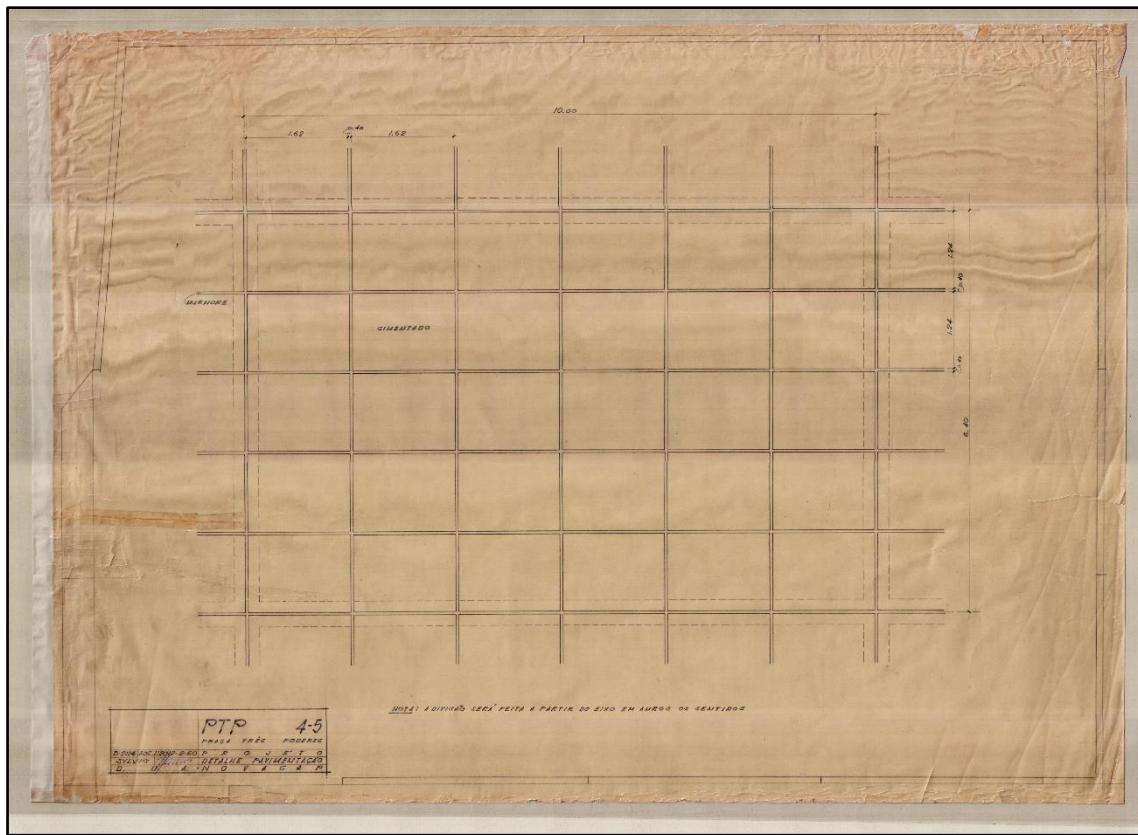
Fev 1960 - Praça dos Três Poderes. PTP 4-5 Escala 1:20 Detalhe da Pavimentação D.U.A.-NOVACAP. Arquivo: PTP - URB - 000-0 - 004-05 - B002114 - 1960-02 - Projeto - Detalhe pavimentação. Fonte: SUPAC/SECULT-DF.
